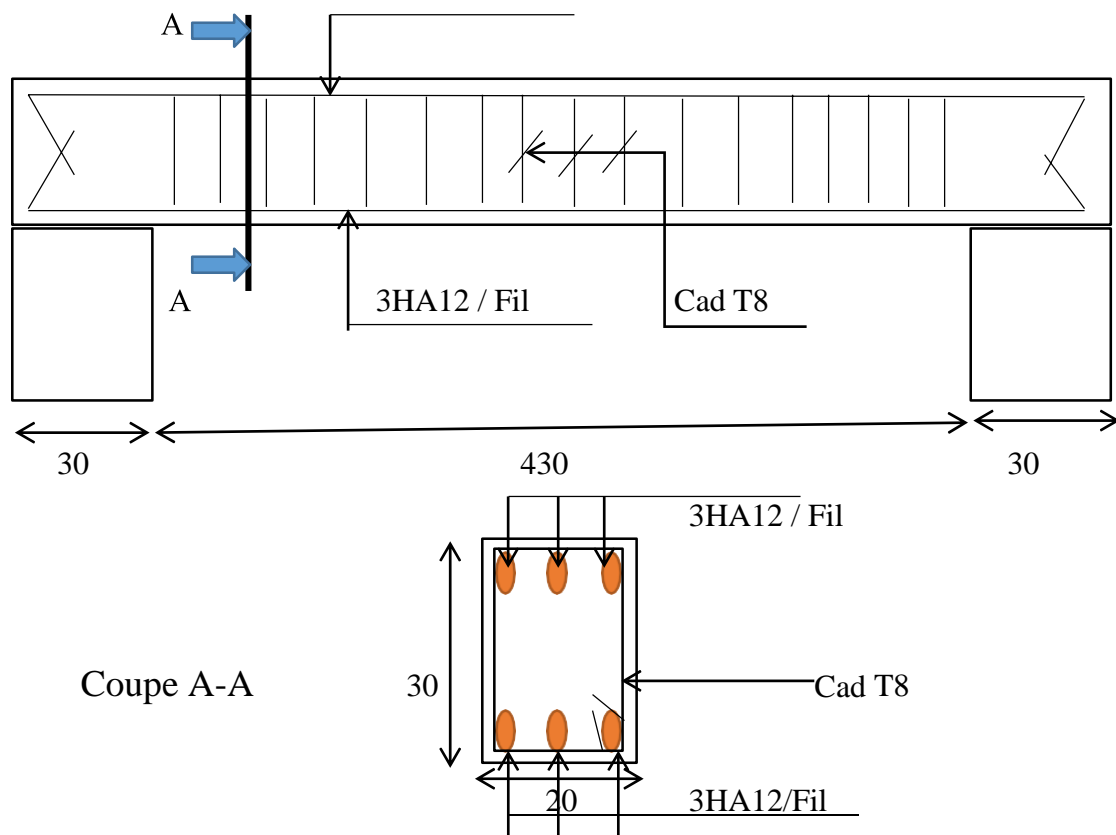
Schéma de ferrailage de la poutre de chaînage
